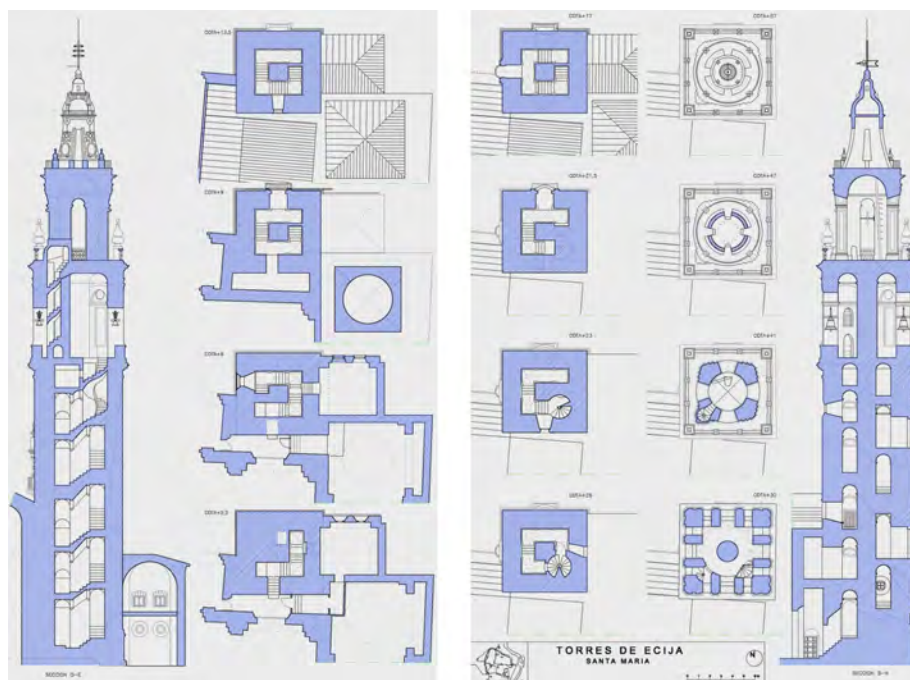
Dibujo plantas y secciones de la torre de Santa María de Écija
